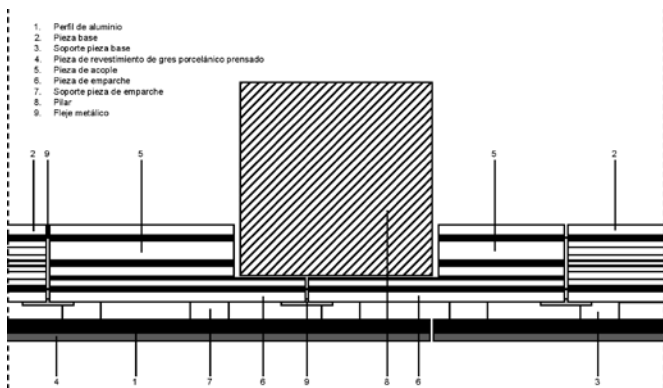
Solución constructiva SIERRAVENT® para encuentro con pilar.
